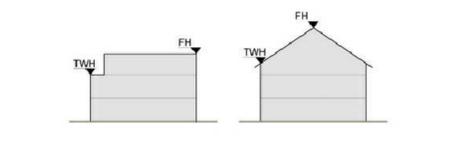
Definition der zulässigen Gebäudehöhen bei den entsprechenden Gebäudetypen
